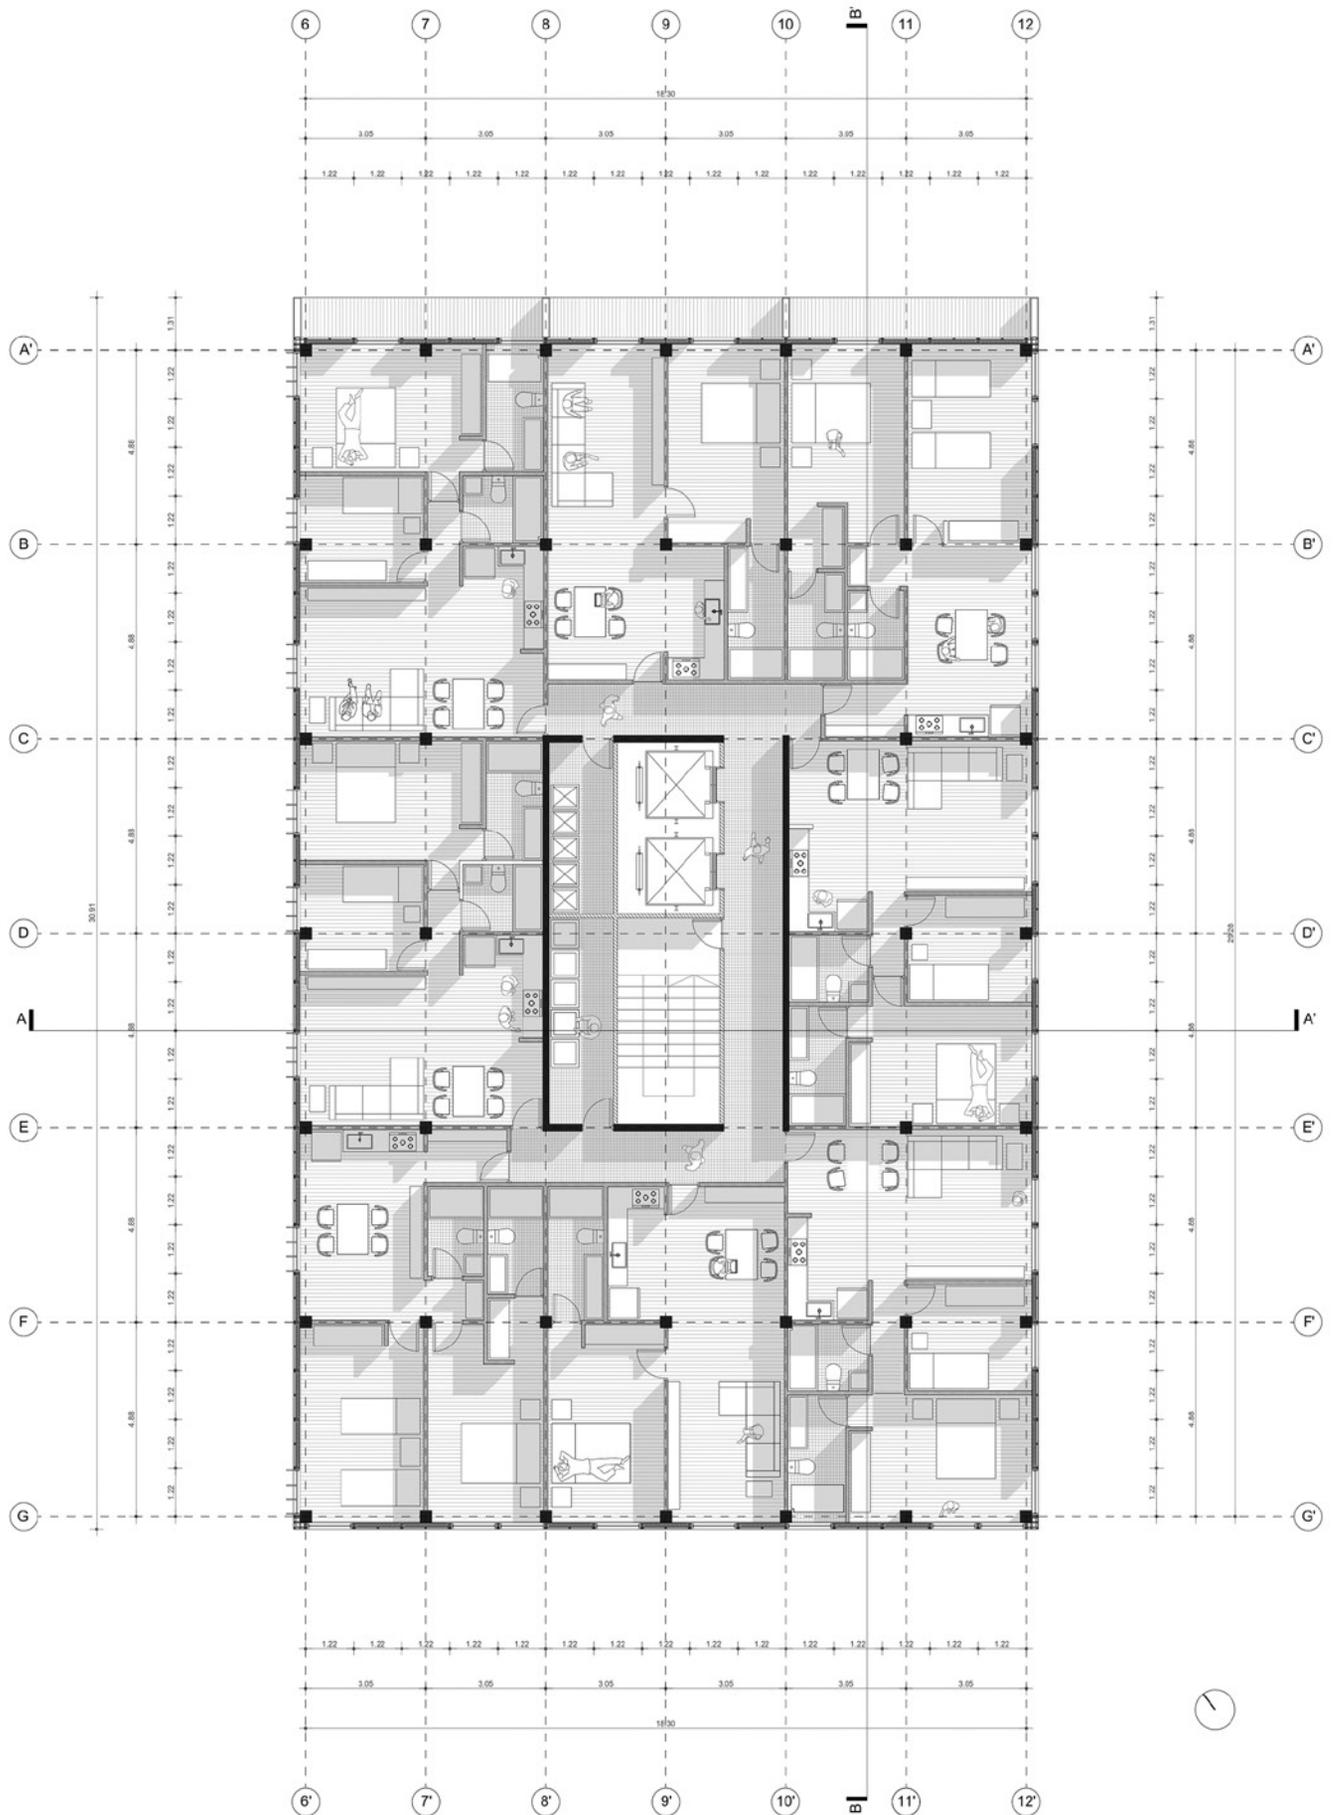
Planta tipo del edificio. Fuente: elaboración propia
